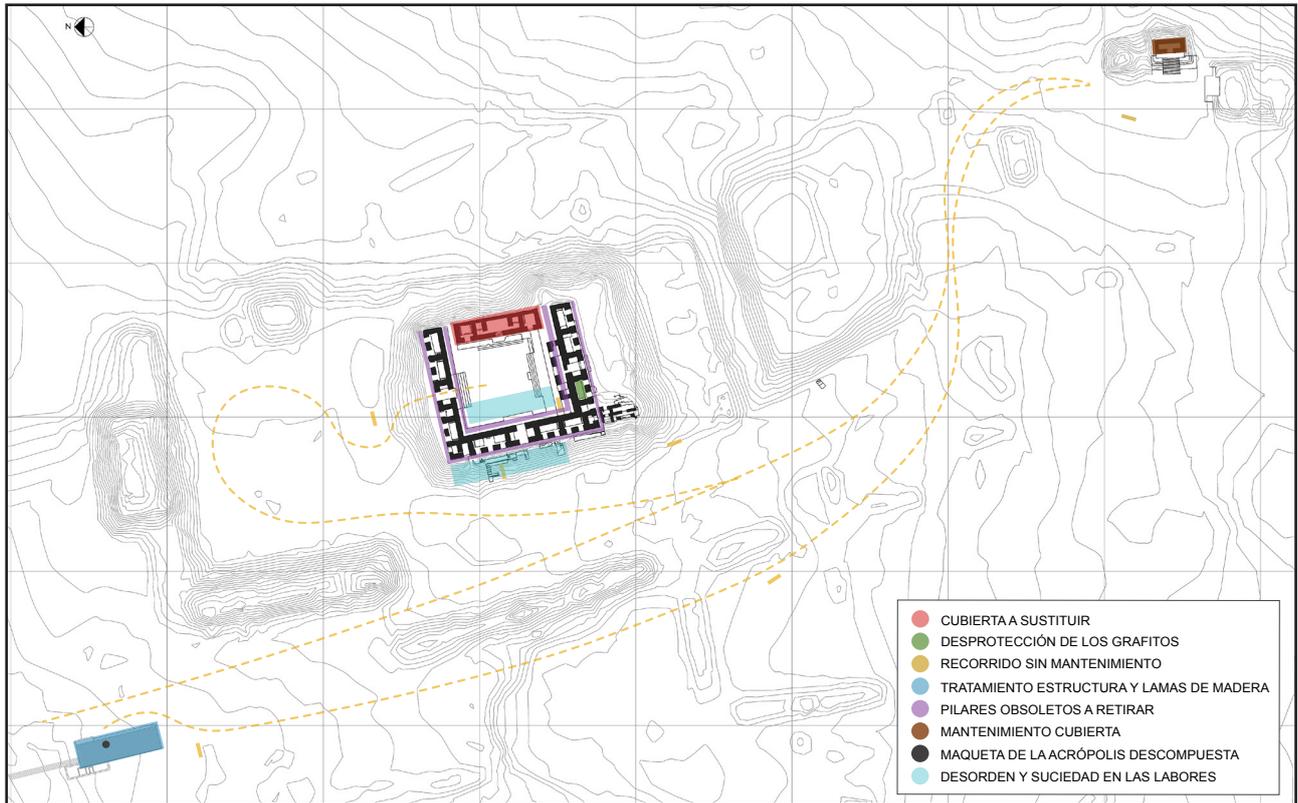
Plano de patologías en el sitio arqueológico de La Blanca. Elaboración propia a partir de plano facilitado por el Proyecto La Blanca.
